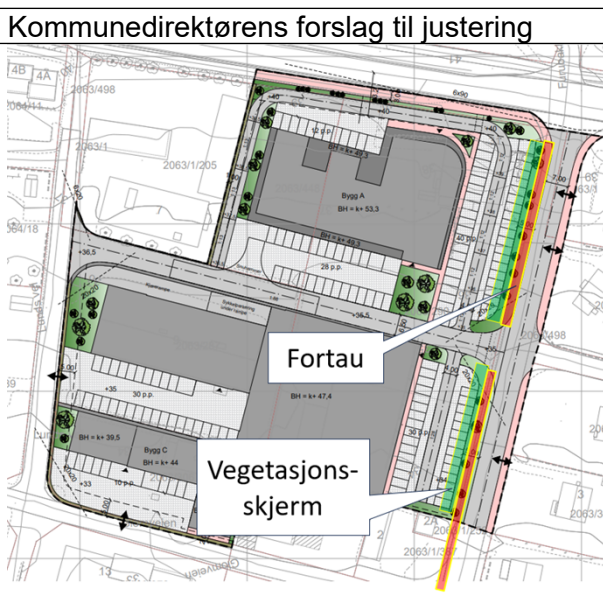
Illustrasjonsplan (ikke juridisk bindende)
